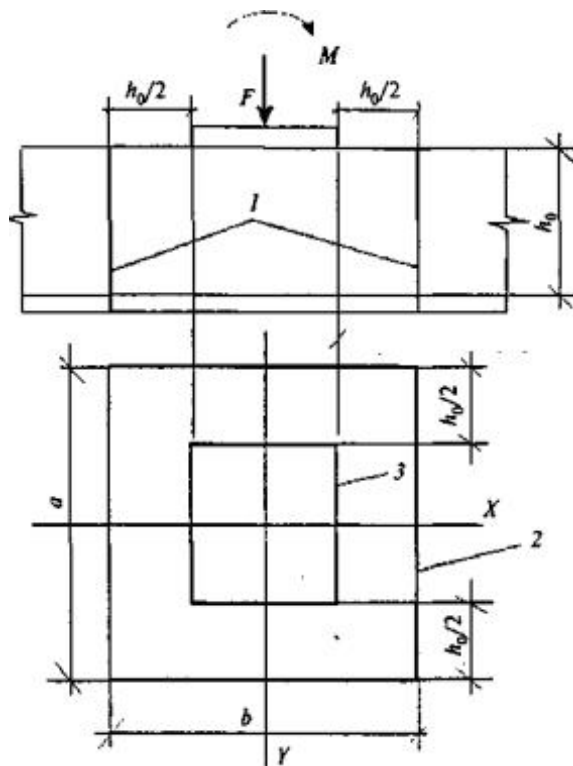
Схема для расчета железобетонных элементов без поперечной арматуры на продавливание: 1 – расчетное поперечное сечение; 2 – контур расчетного поперечного сечения; 3 – контур площадки приложения нагрузки
